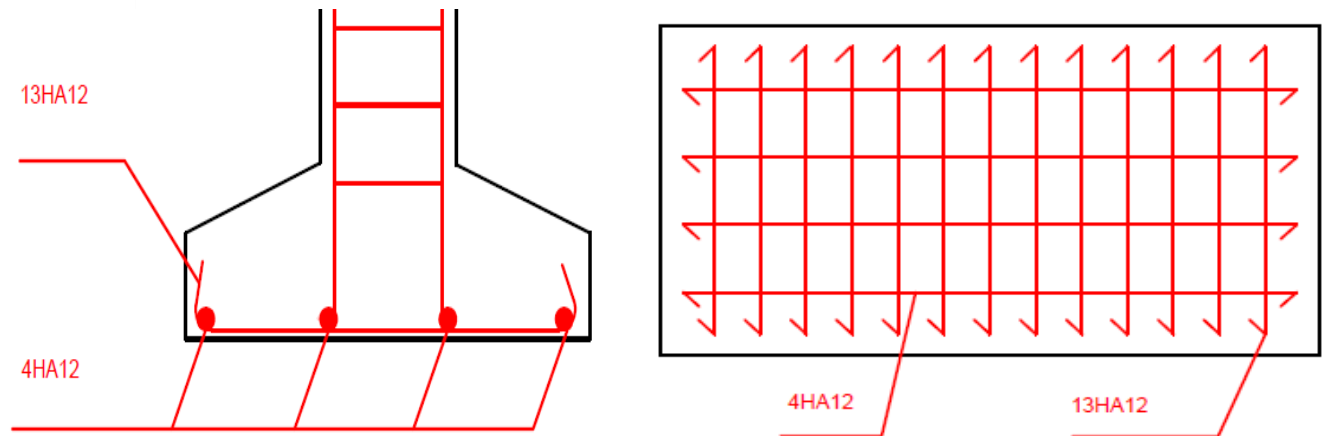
Schéma de ferrailage d'une semelle filante sous poteau.
